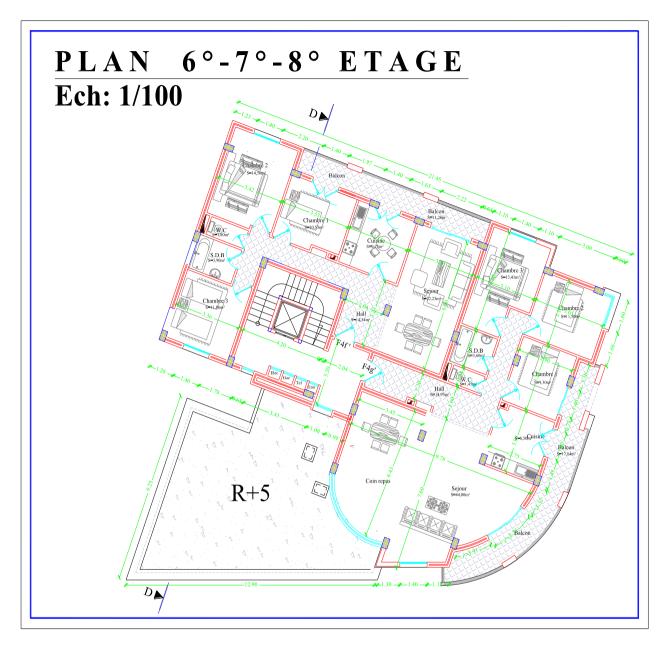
Plan étage courant: $6 \rightarrow 8$
